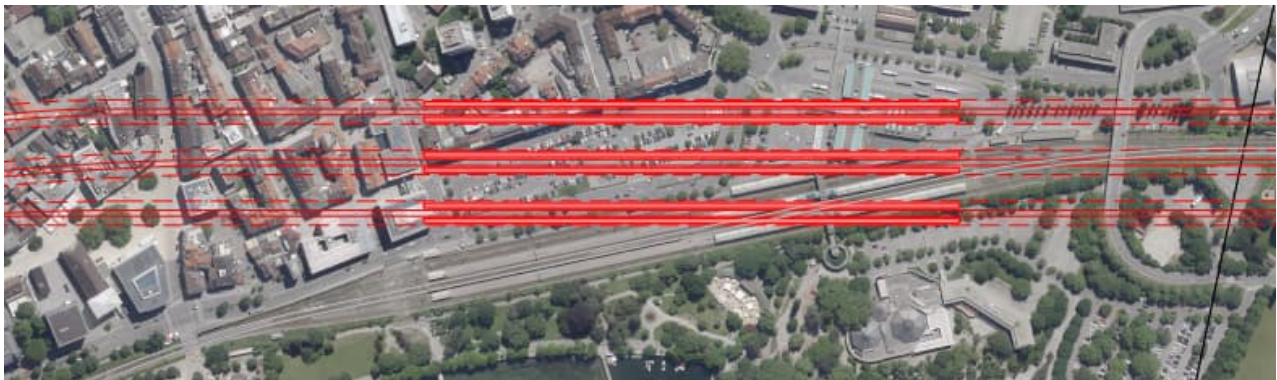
Unterfahrung Bestandsbauwerke im Bereich Bahnhof Bregenz
